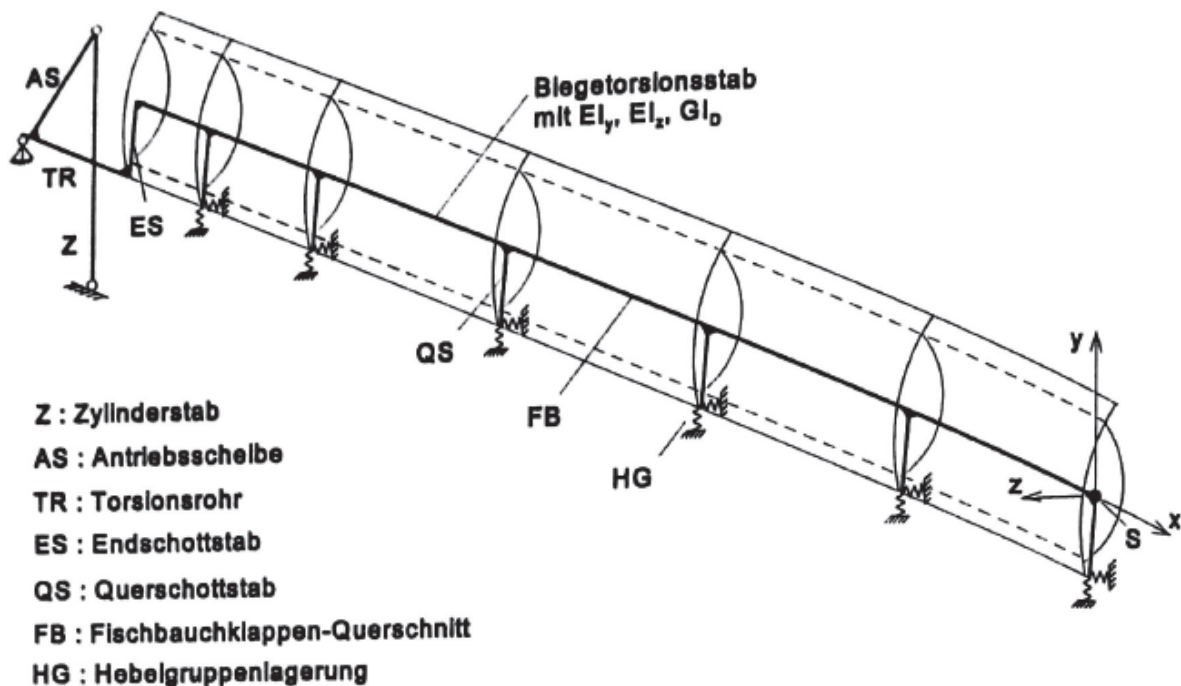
Stabwerksmodell der Fischbauchklappe einschließlich Lagerung [19]
